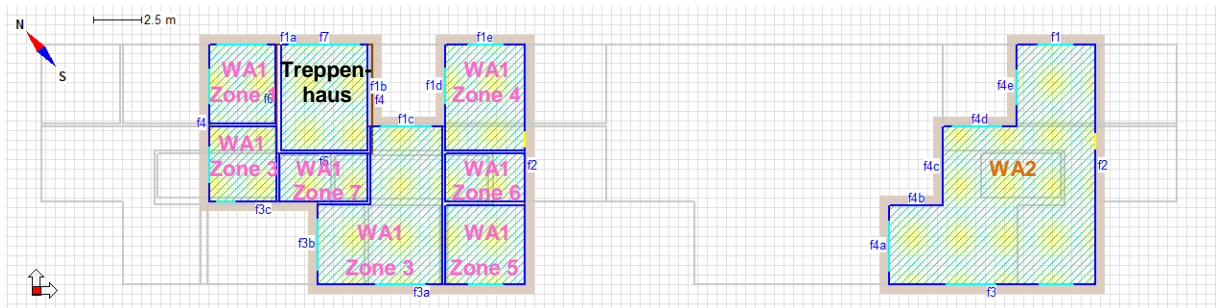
Grundriss der Attika des Gebäudes in IDA ICE aufgebauten Wohngeschossmodells „Neubau hybrid“ mit Zonenaufteilung.
